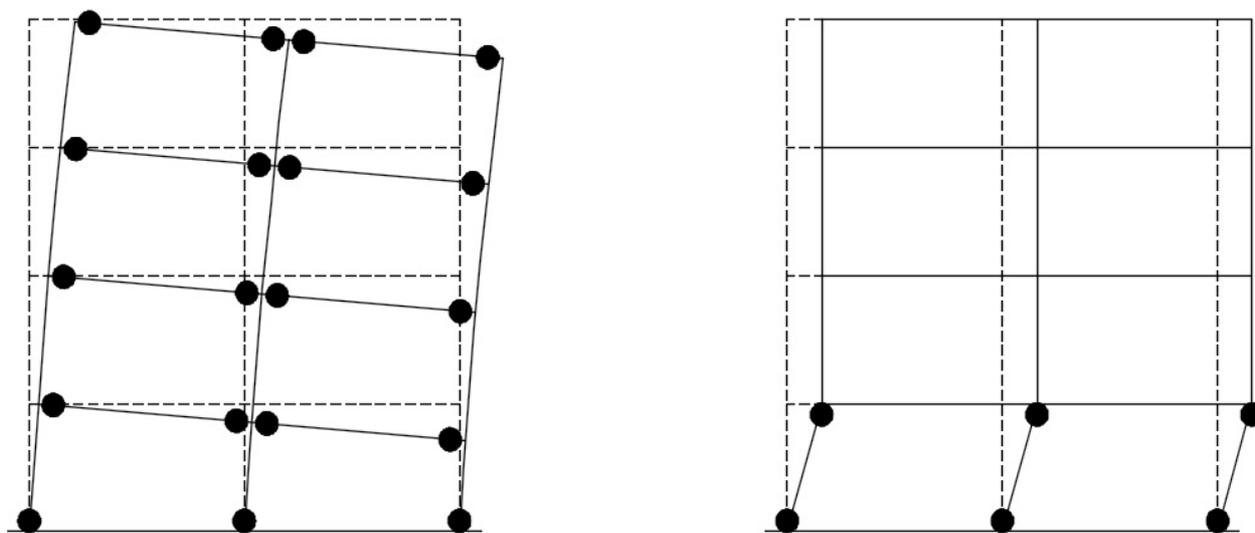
Configurazioni limite dei meccanismi di collasso di un telaio multipiano (4-a Mensola equivalente, 4-a Piano debole).
